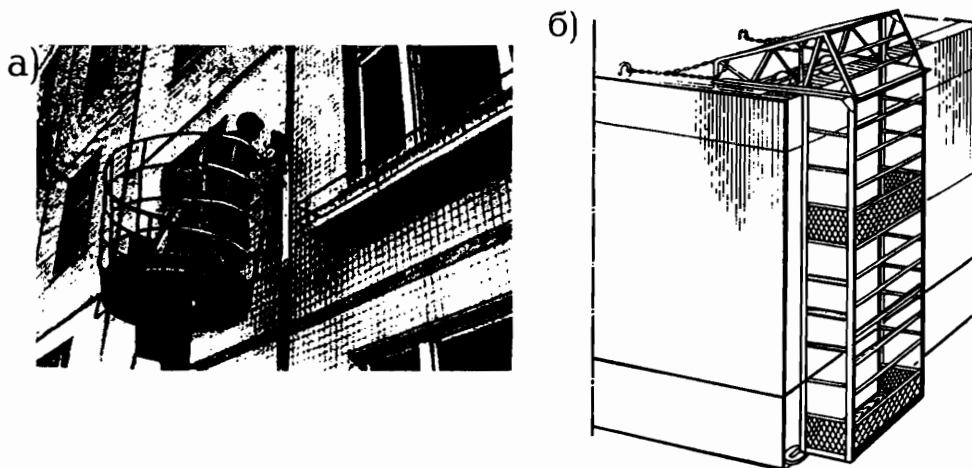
Герметизация стыков между панелями: с наружной стороны здания; а - с автовышки после завершения монтажа здания; б - по ходу монтажа с навесной площадки на перекрытии
